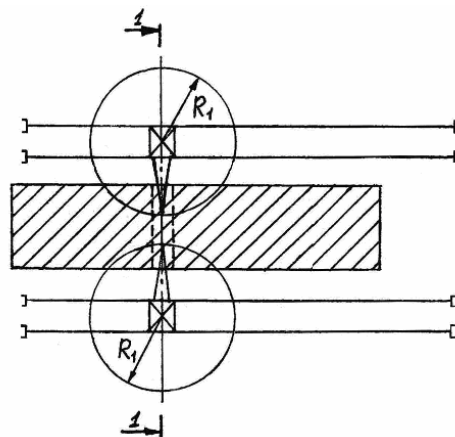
Схема розміщення в плані баштових кранів при монтажі ними одного елемента покриття
